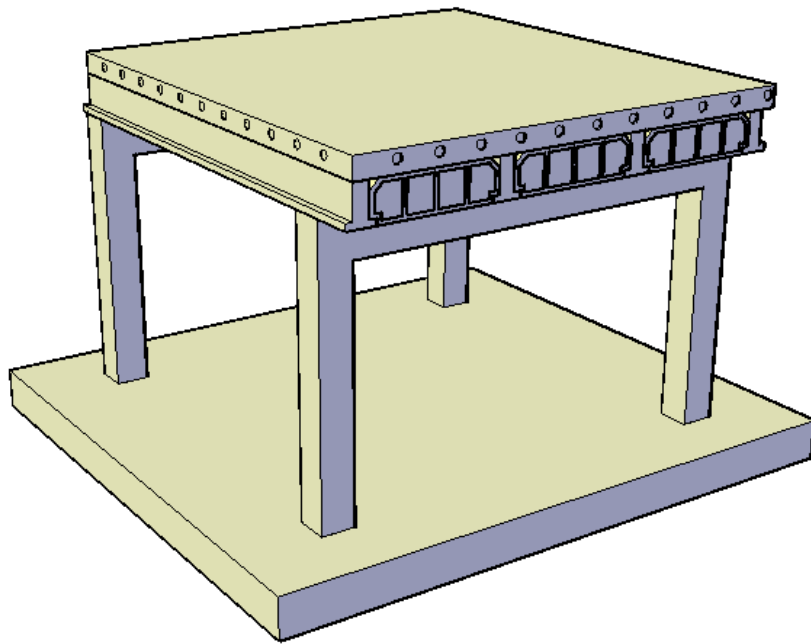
Entrepiso o Techo terminado, construido con la solución vigüeta-bovedilla.
